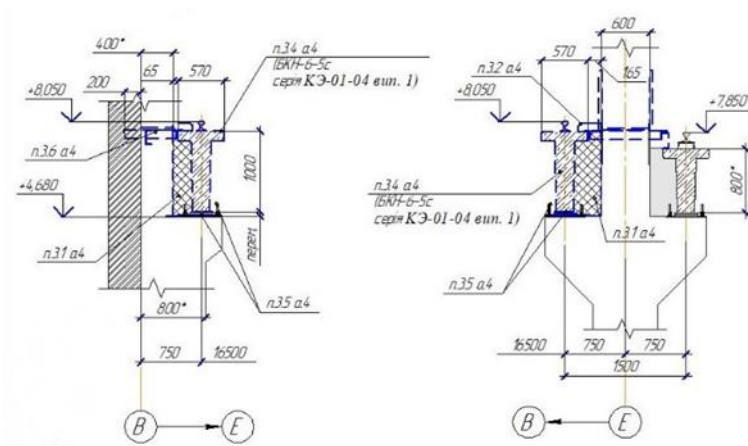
Схеми демонтажу залізобетонної підкранової балки
